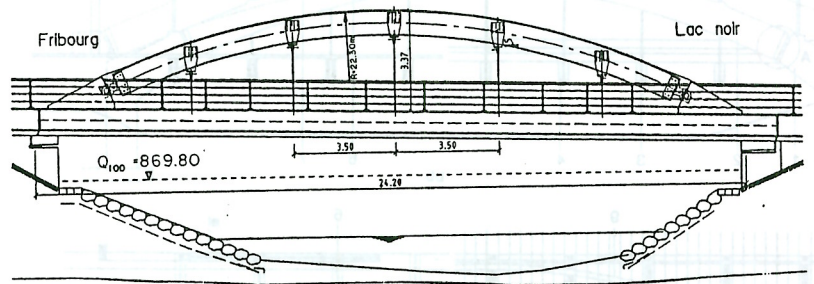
2 自立式アーチ橋（Zollhaus 橋、スイス、1998 年架設）
